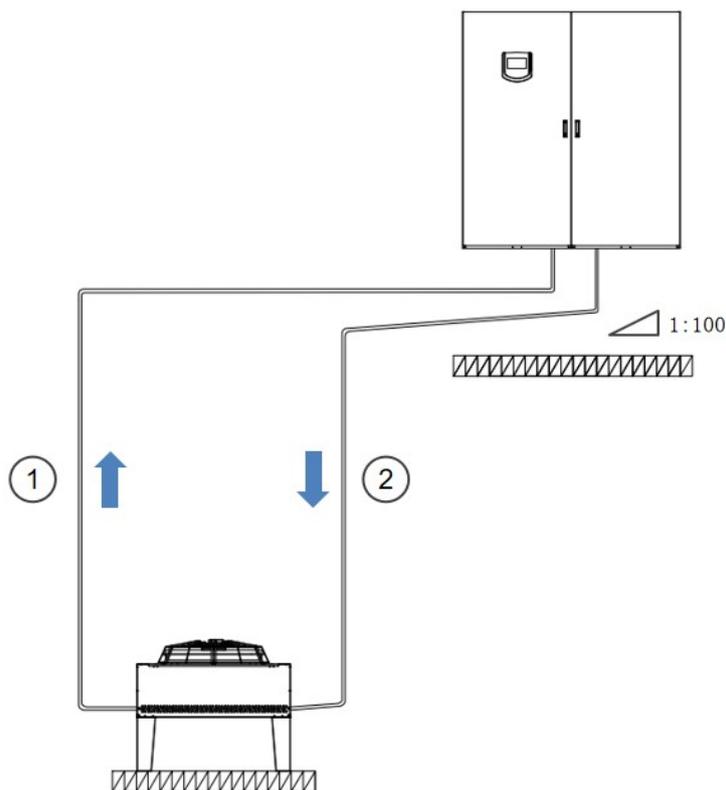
Схема установки стандартного конденсатора ниже внутреннего блока
